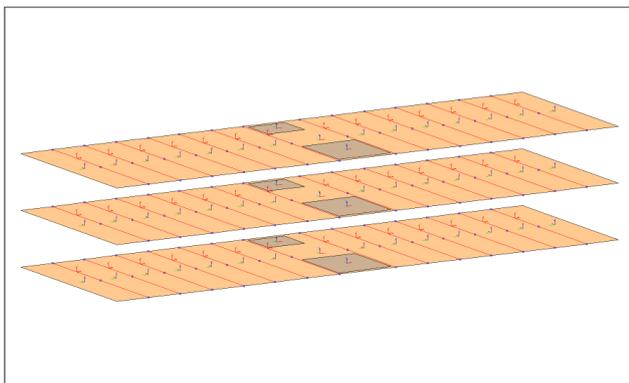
Strukturelemente der drei Decken inkl. Deckenfugen
